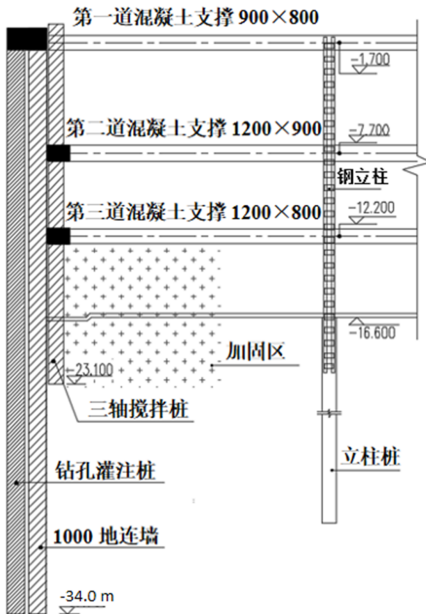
基坑典型断面设计图(尺寸:mm,标高:m)
